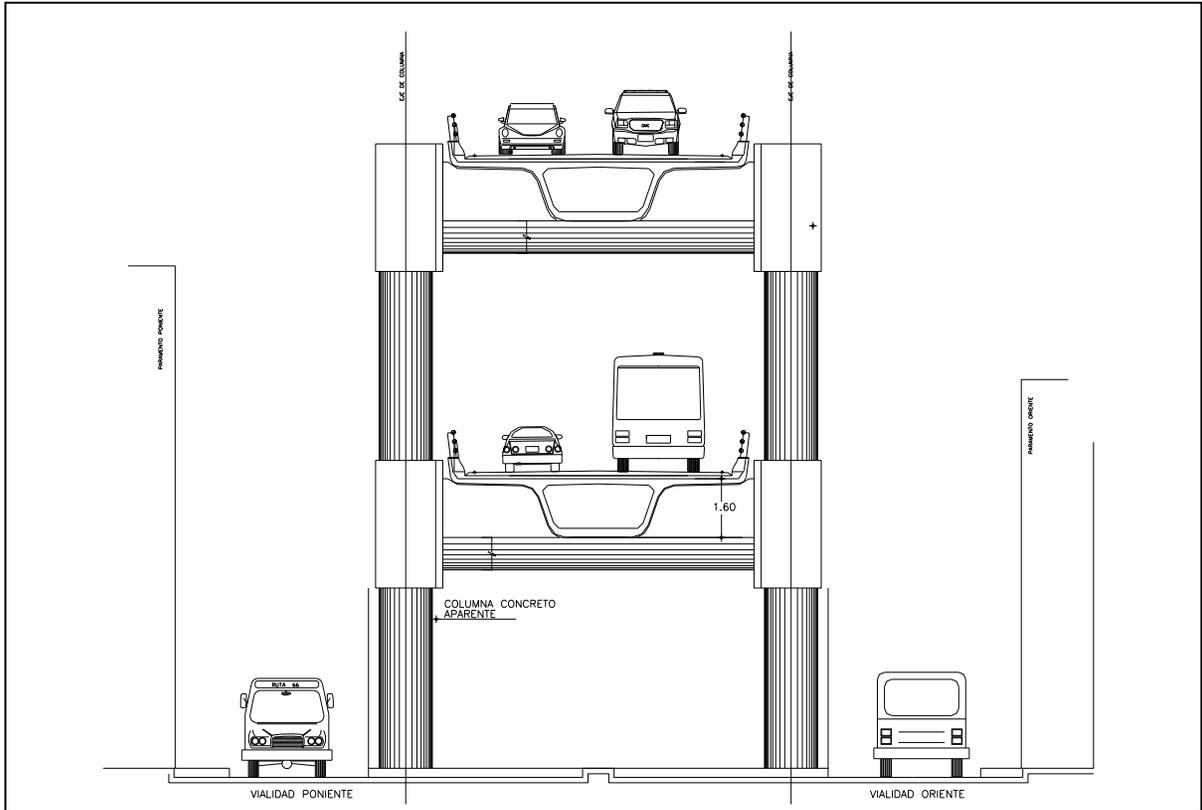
Corte 3-3'. Elevación y ampliación de las Avenidas Plan de Muyuguarda y Cafetales y sentidos de circulación.
